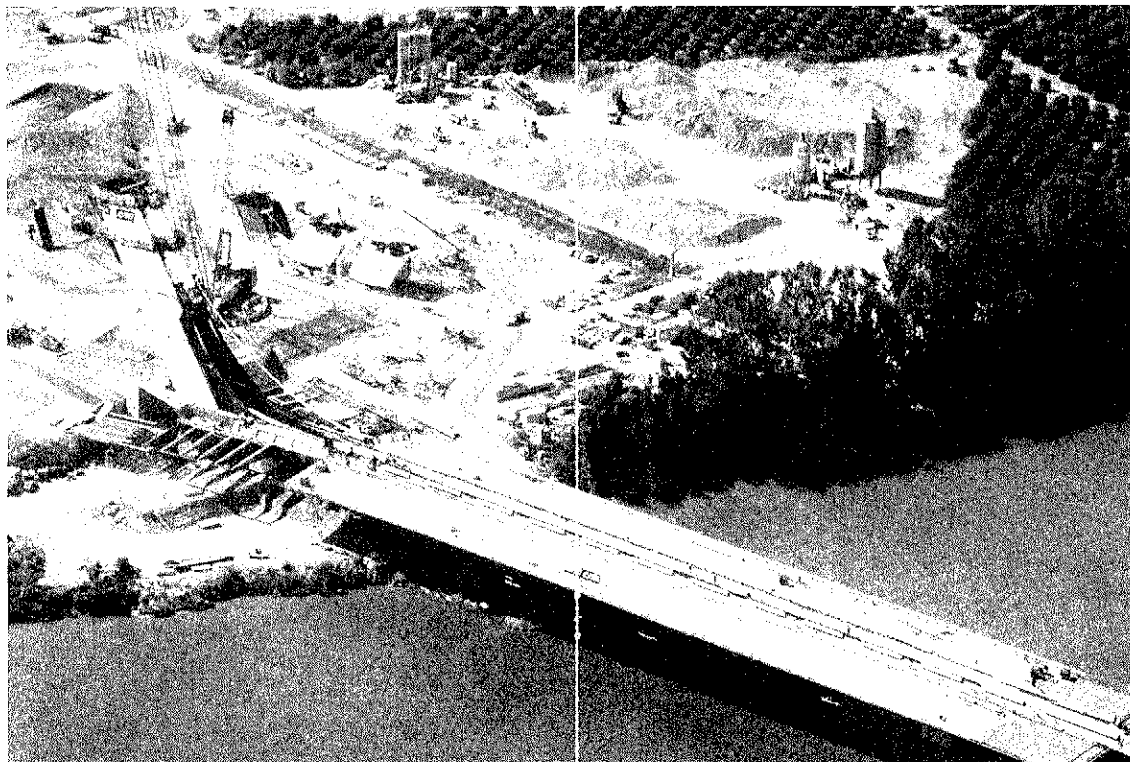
Vista general del tablero y del mástil, en fase de ejecución.
